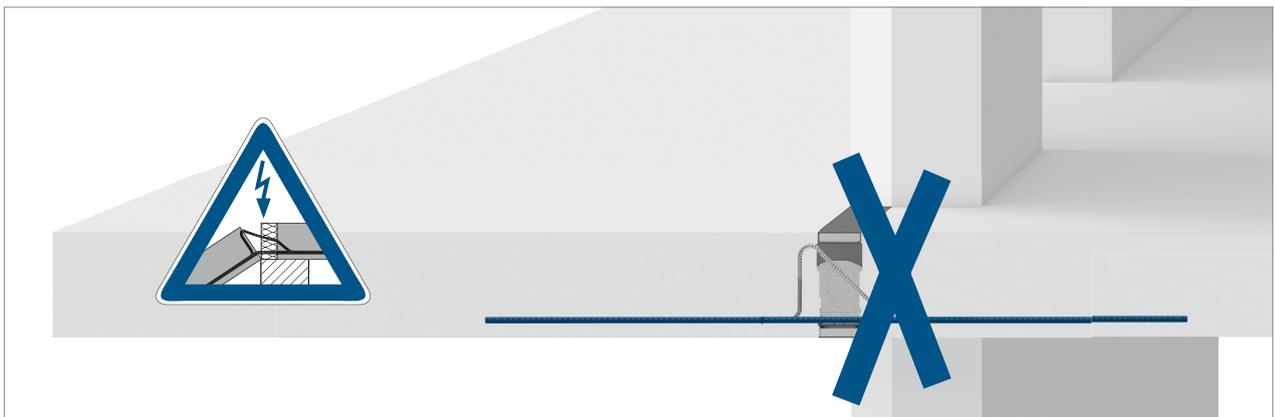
Schöck Isokorb® T Typ KL falscher Einbau: Zugstab unten
